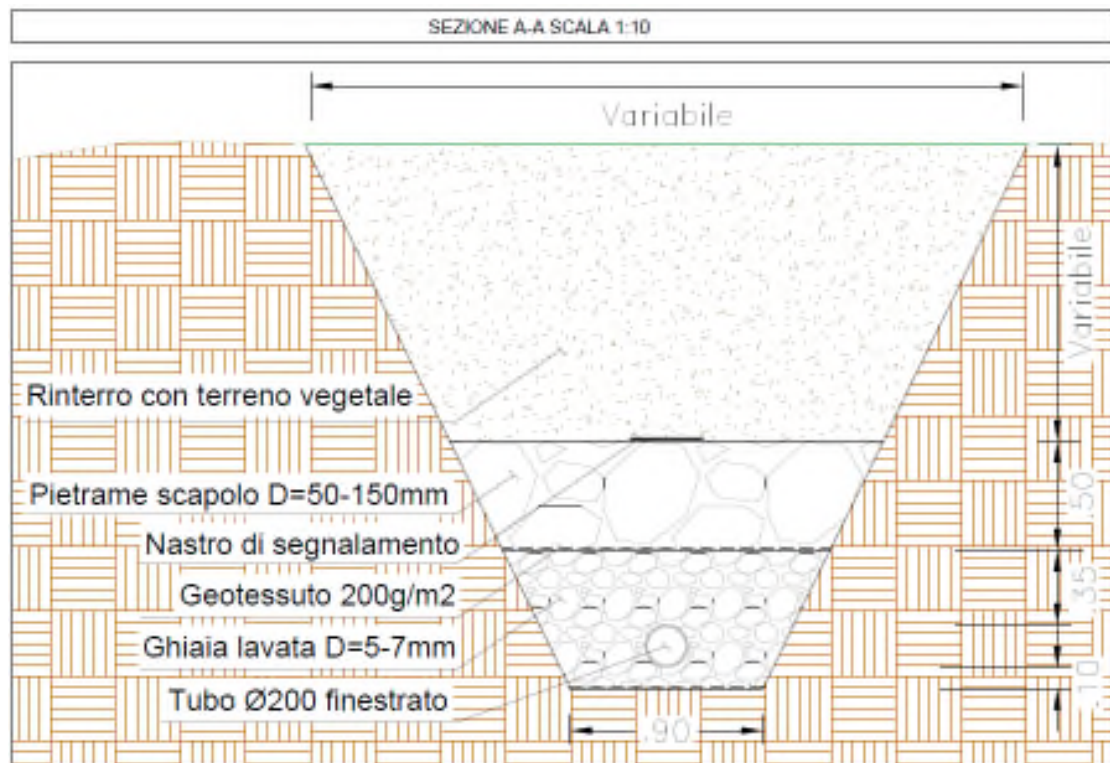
SEZIONE TIPO 1 TRINCEA DRENANTE PROFONDA (ZONA DI MONTE)
